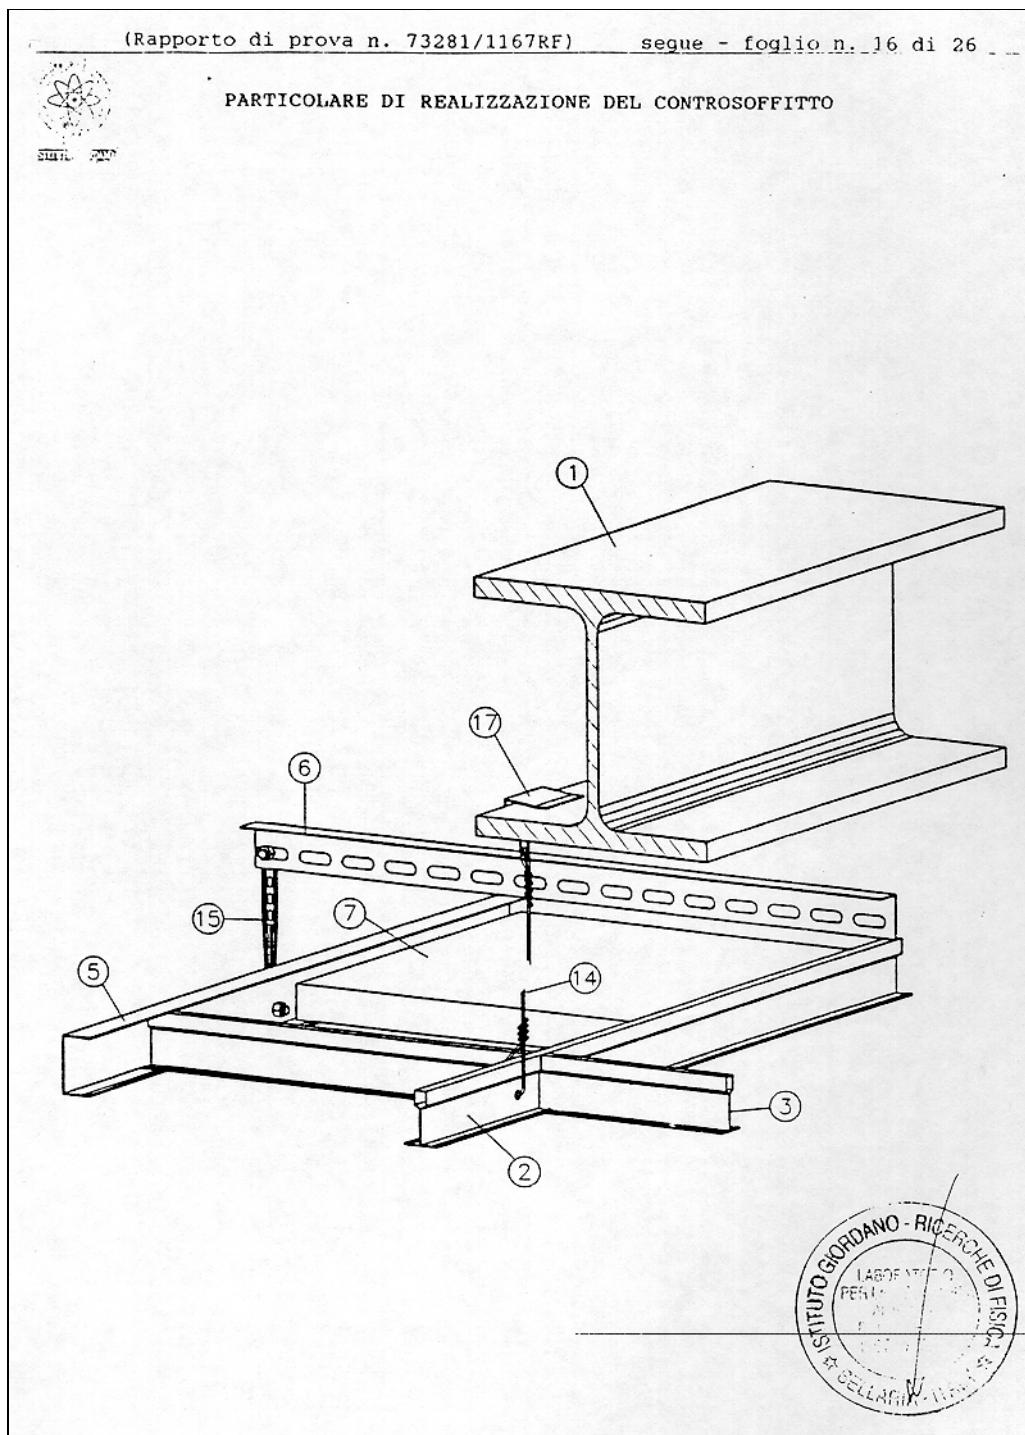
PARTICOLARE DI REALIZZAZIONE DEL CONTROSOFFITTO
